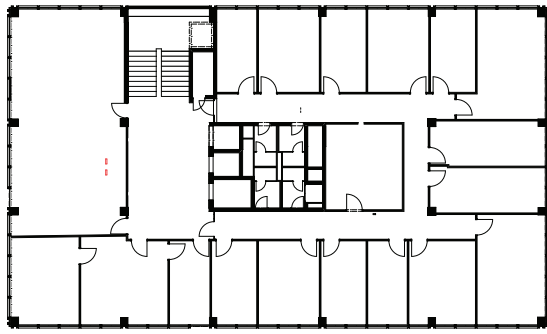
Grundriss 5. Obergeschoss Bestand
